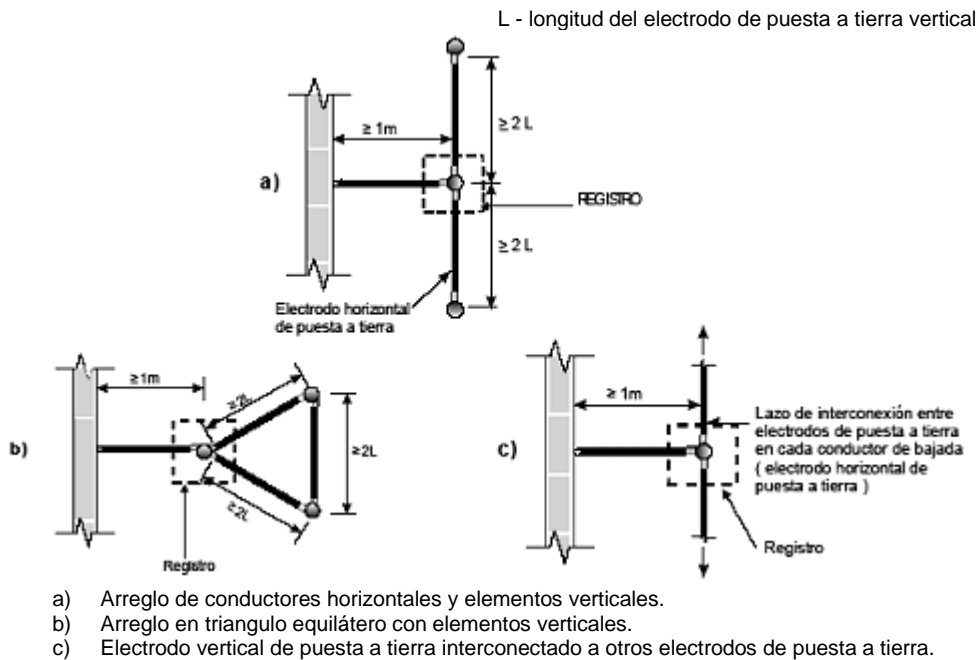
Vista de planta de los arreglos típicos para formar el electrodo de puesta a tierra que conecta a cada conductor de bajada del sistema exterior de protección.
